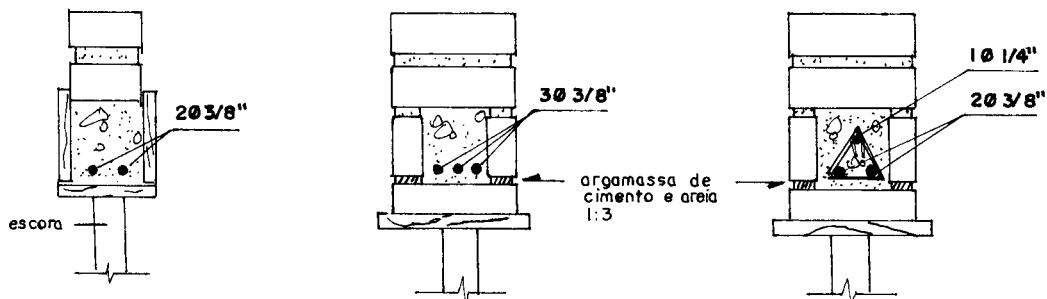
Vergas em alvenaria de tijolo maciço para vãos entre 1,00m e 2,00m
